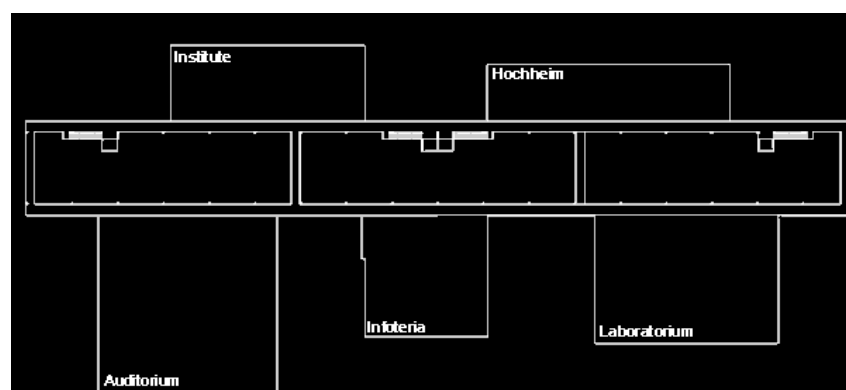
Obergeschoss- Grundriss des Spine
